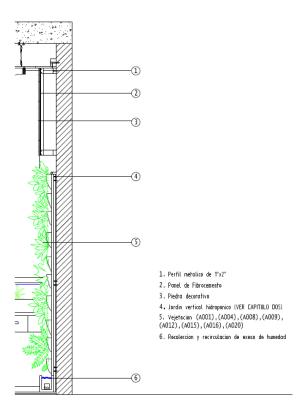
Detalle constructivo de muro con jardinería vertical. Fuente: (Cevallos, 2014)
